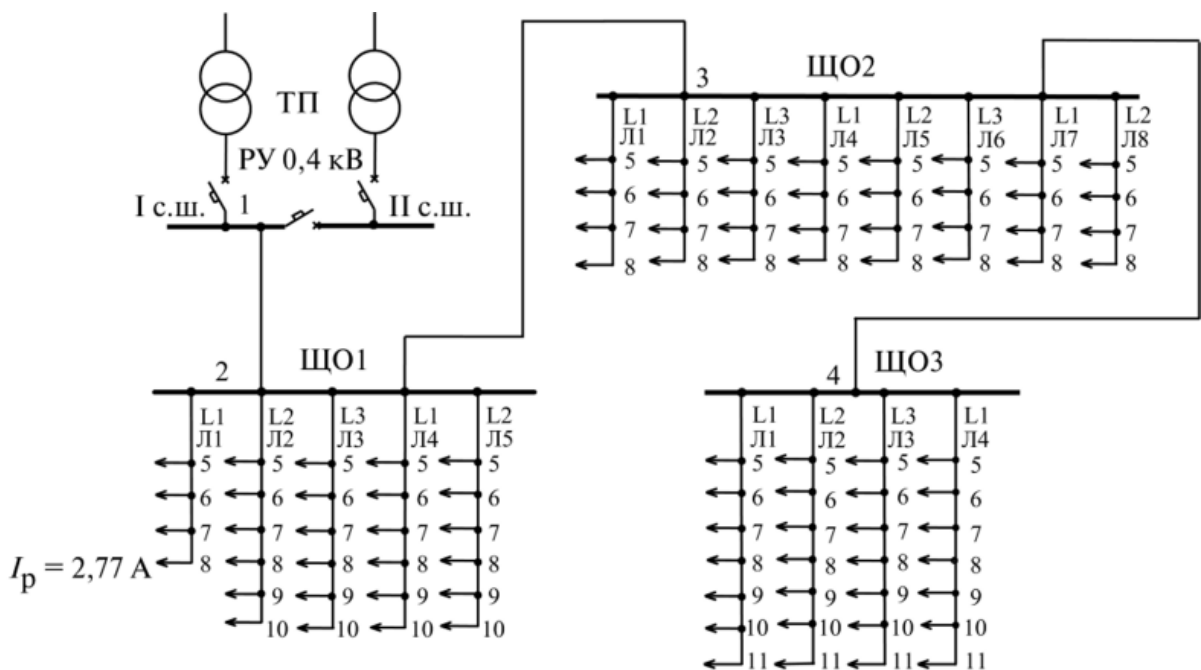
Расчетная схема сети рабочего освещения столовой
